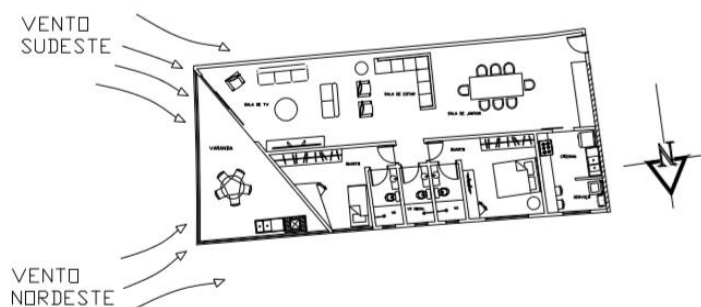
Planta baixa do apartamento tipo 3. Fonte: elaborado pelos autores.
